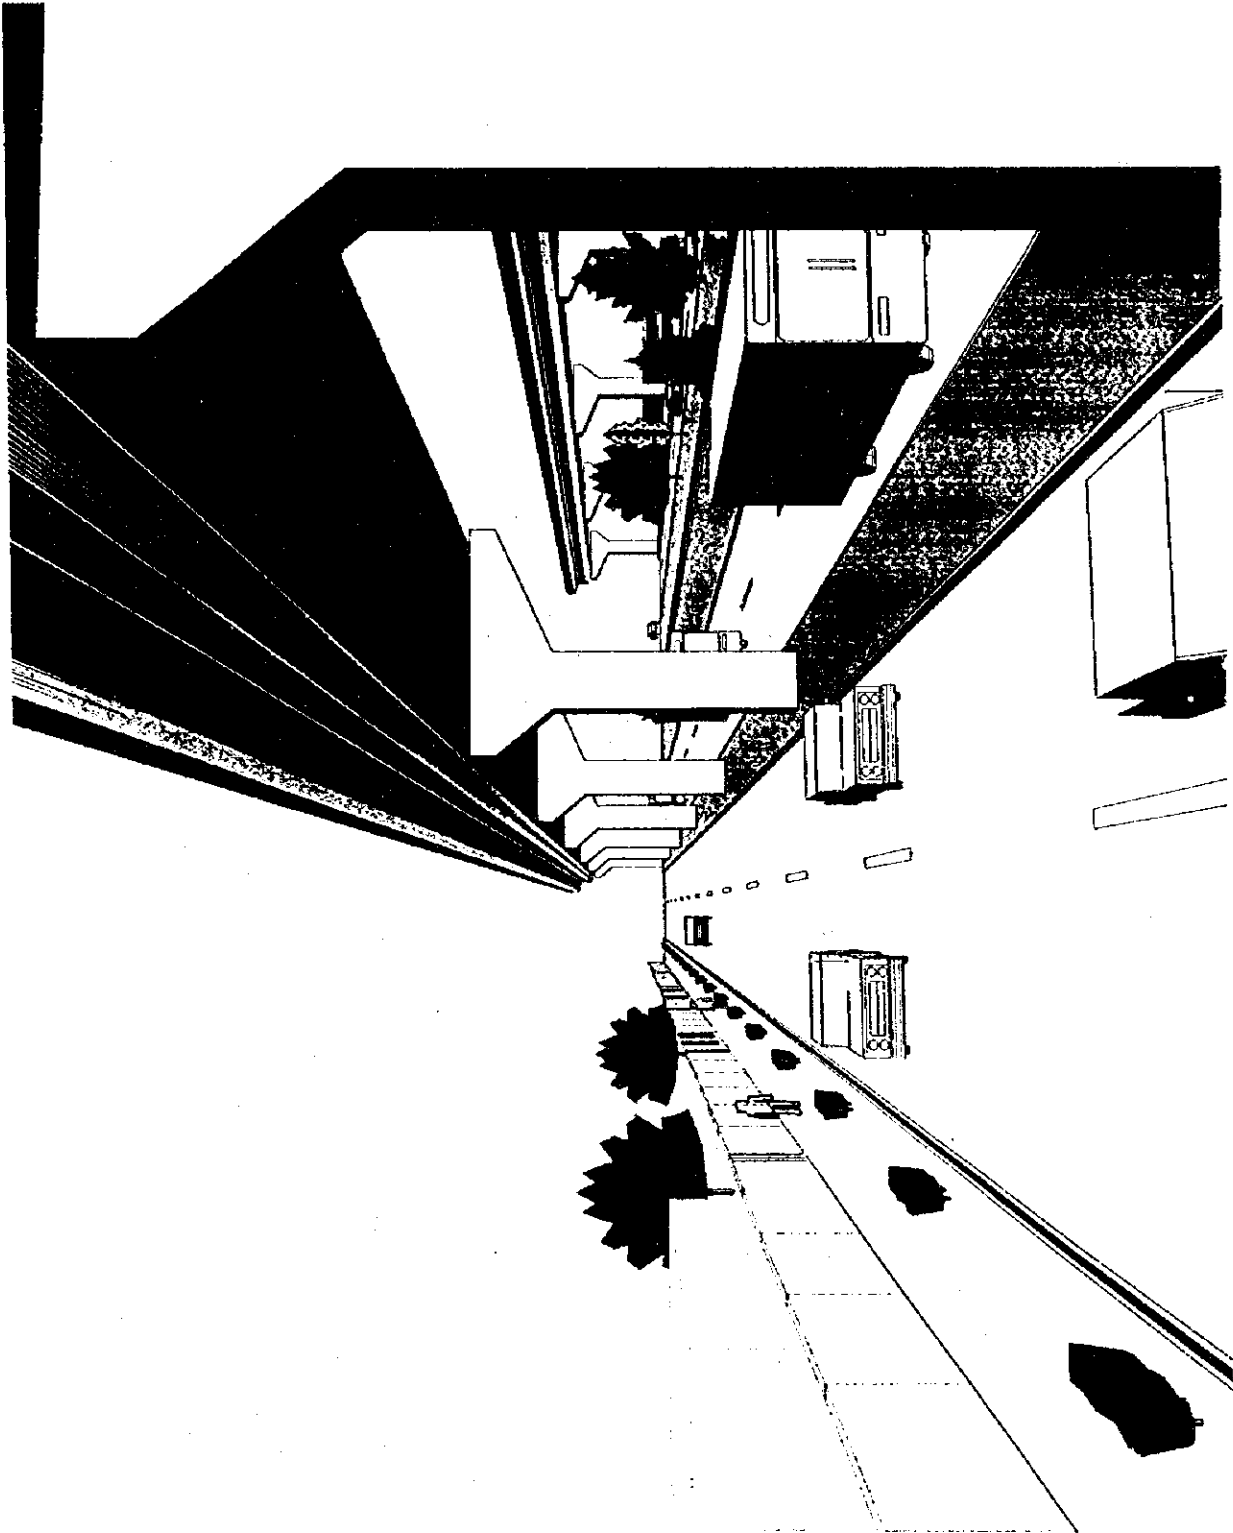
Plano tridimensional de la Alternativa B en la Avenida Quito (1)
